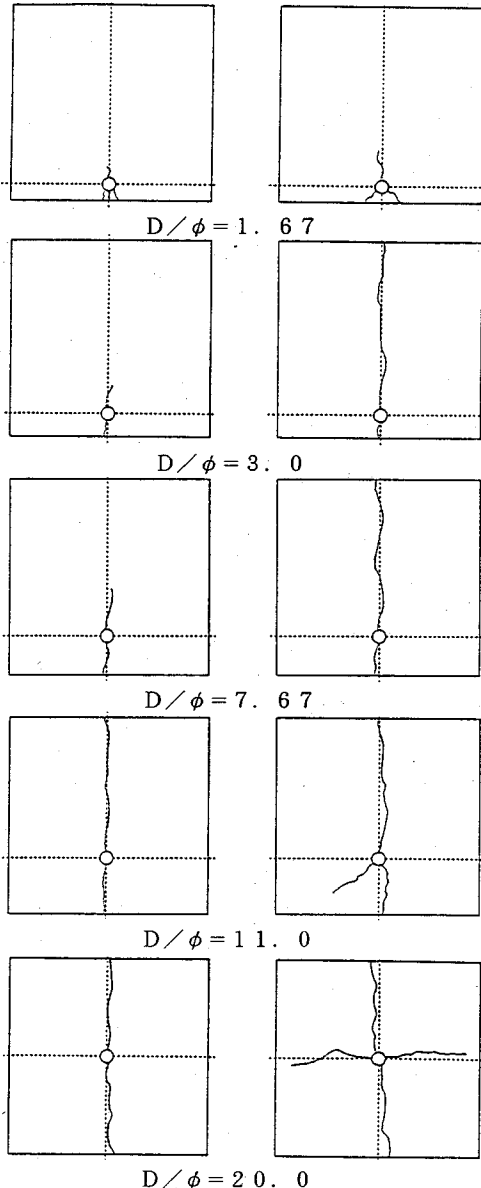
ひび割れ状況(左側:電食実験, 右側:静的破砕剤実験)
